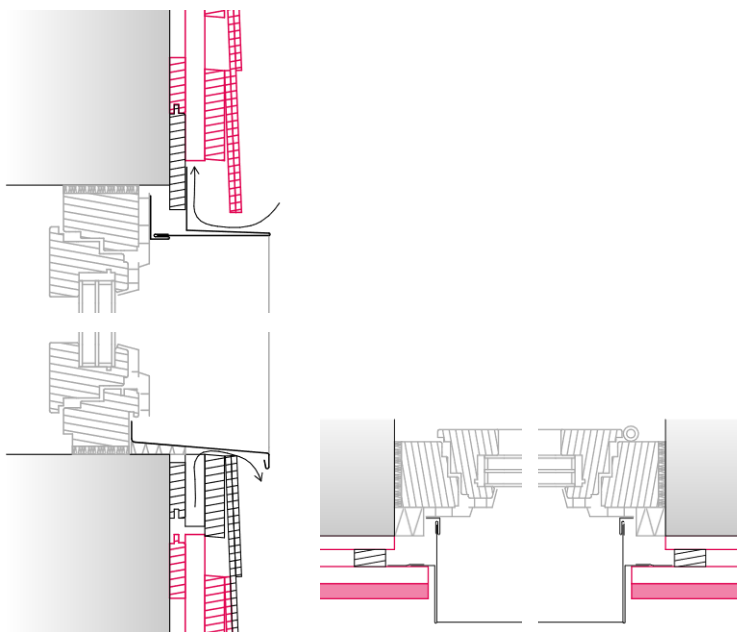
Anschlussdetail 3-3 (links) und B-B (rechts) mit Metallrahmen
